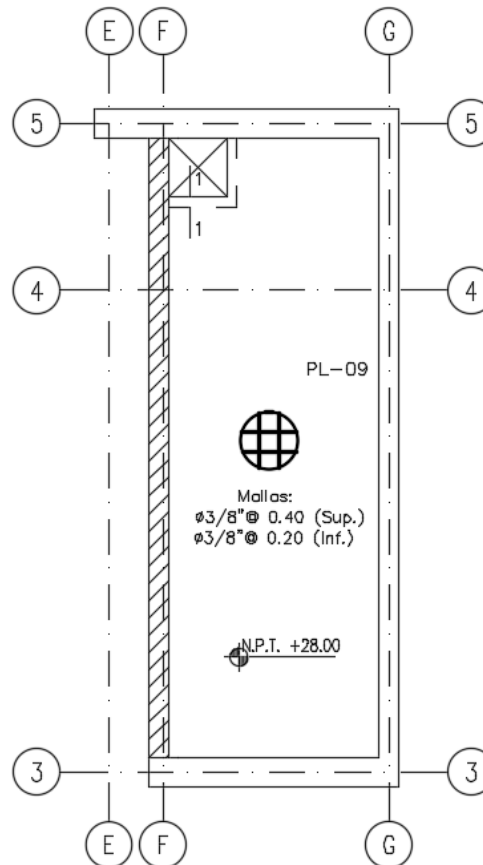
Disposición final de acero en la losa de techo del tanque elevado.
